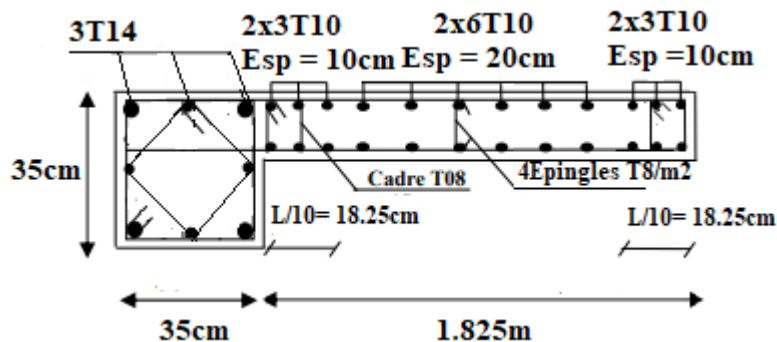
Dessin de ferrailage du voile V2 du 2<sup>ème</sup> étage
